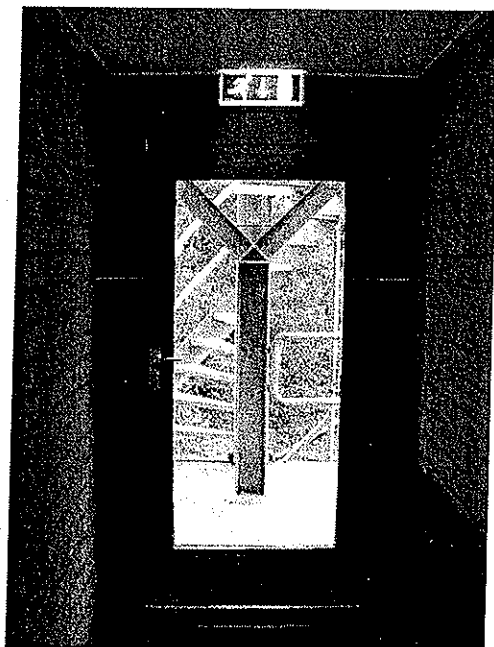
Zicht op de dakschilden vanuit het gebouw.
